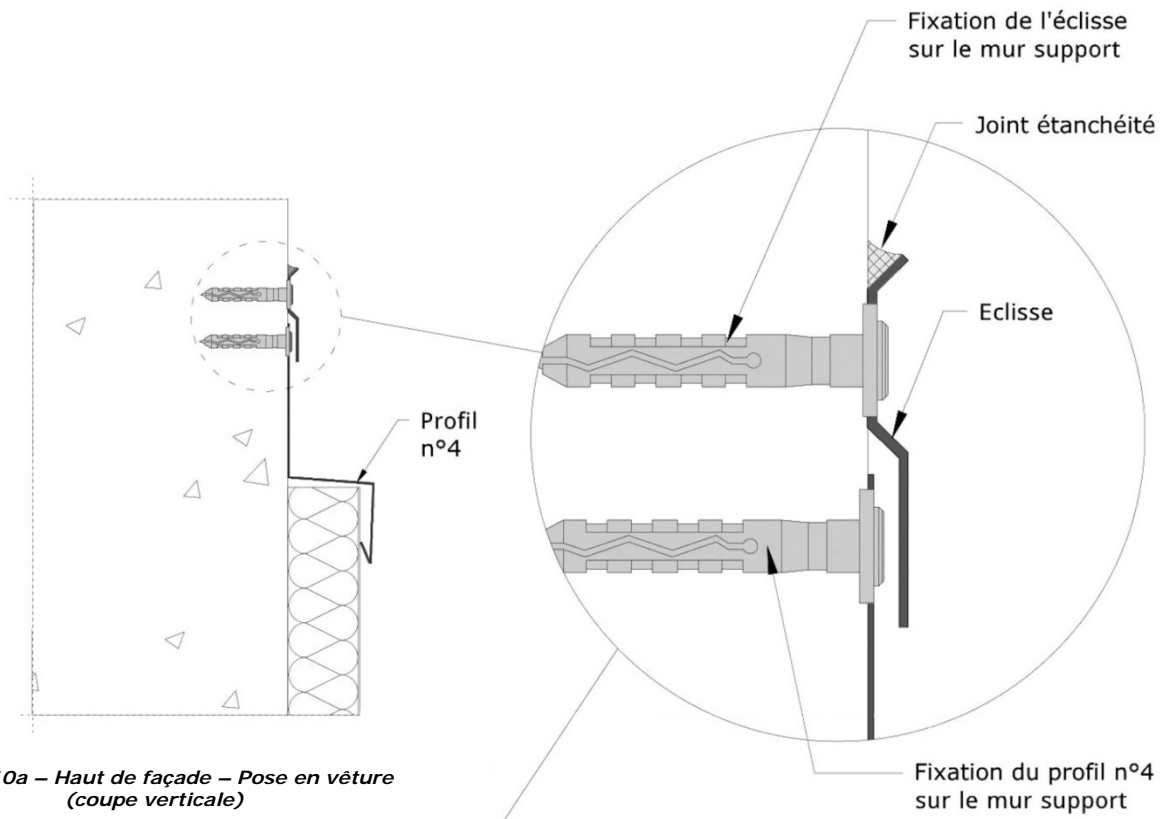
Haut de façade – Pose en vêtture (coupe verticale)
